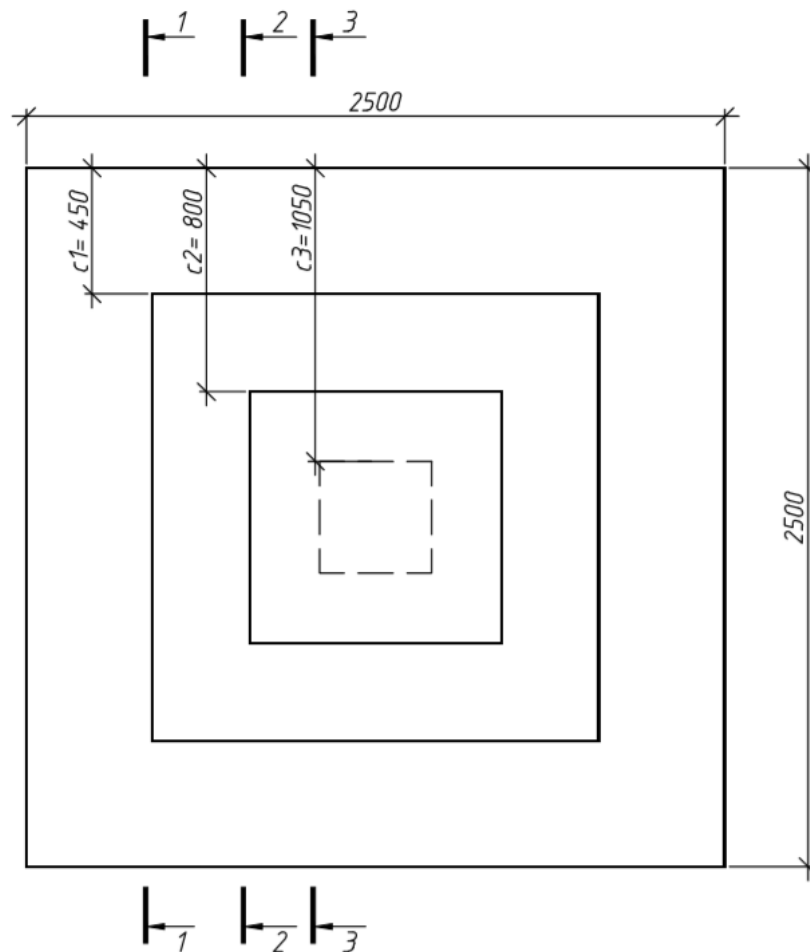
Схема сечений к расчету армирования подошвы фундамента
